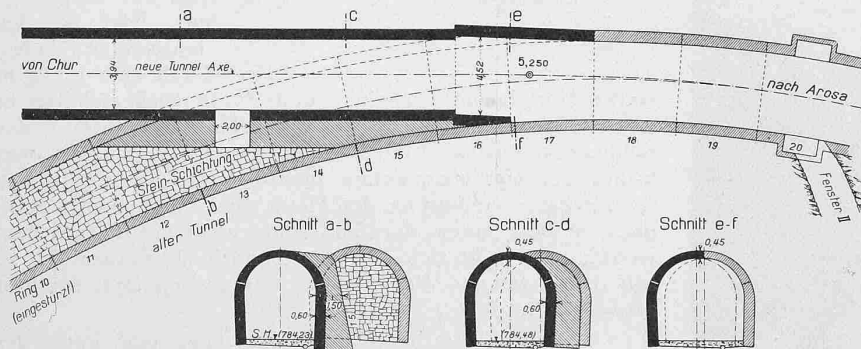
Einführung des neuen Tunnels in den bestehenden. — Masstab 1 : 400.
